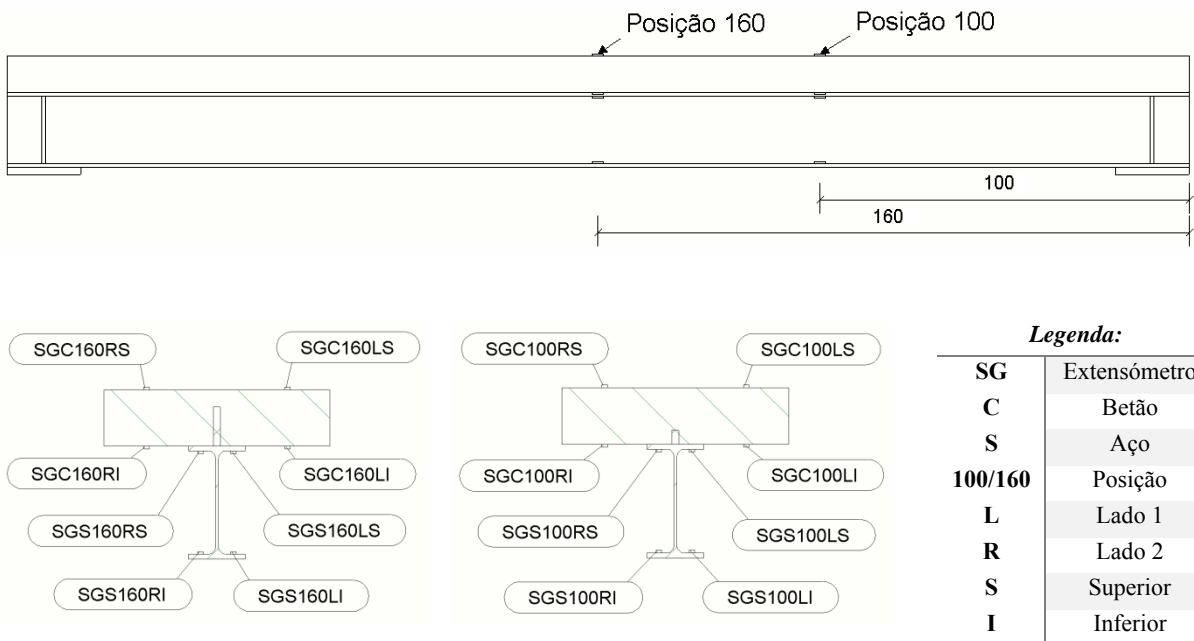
Disposição dos extensómetros na secção transversal da viga
